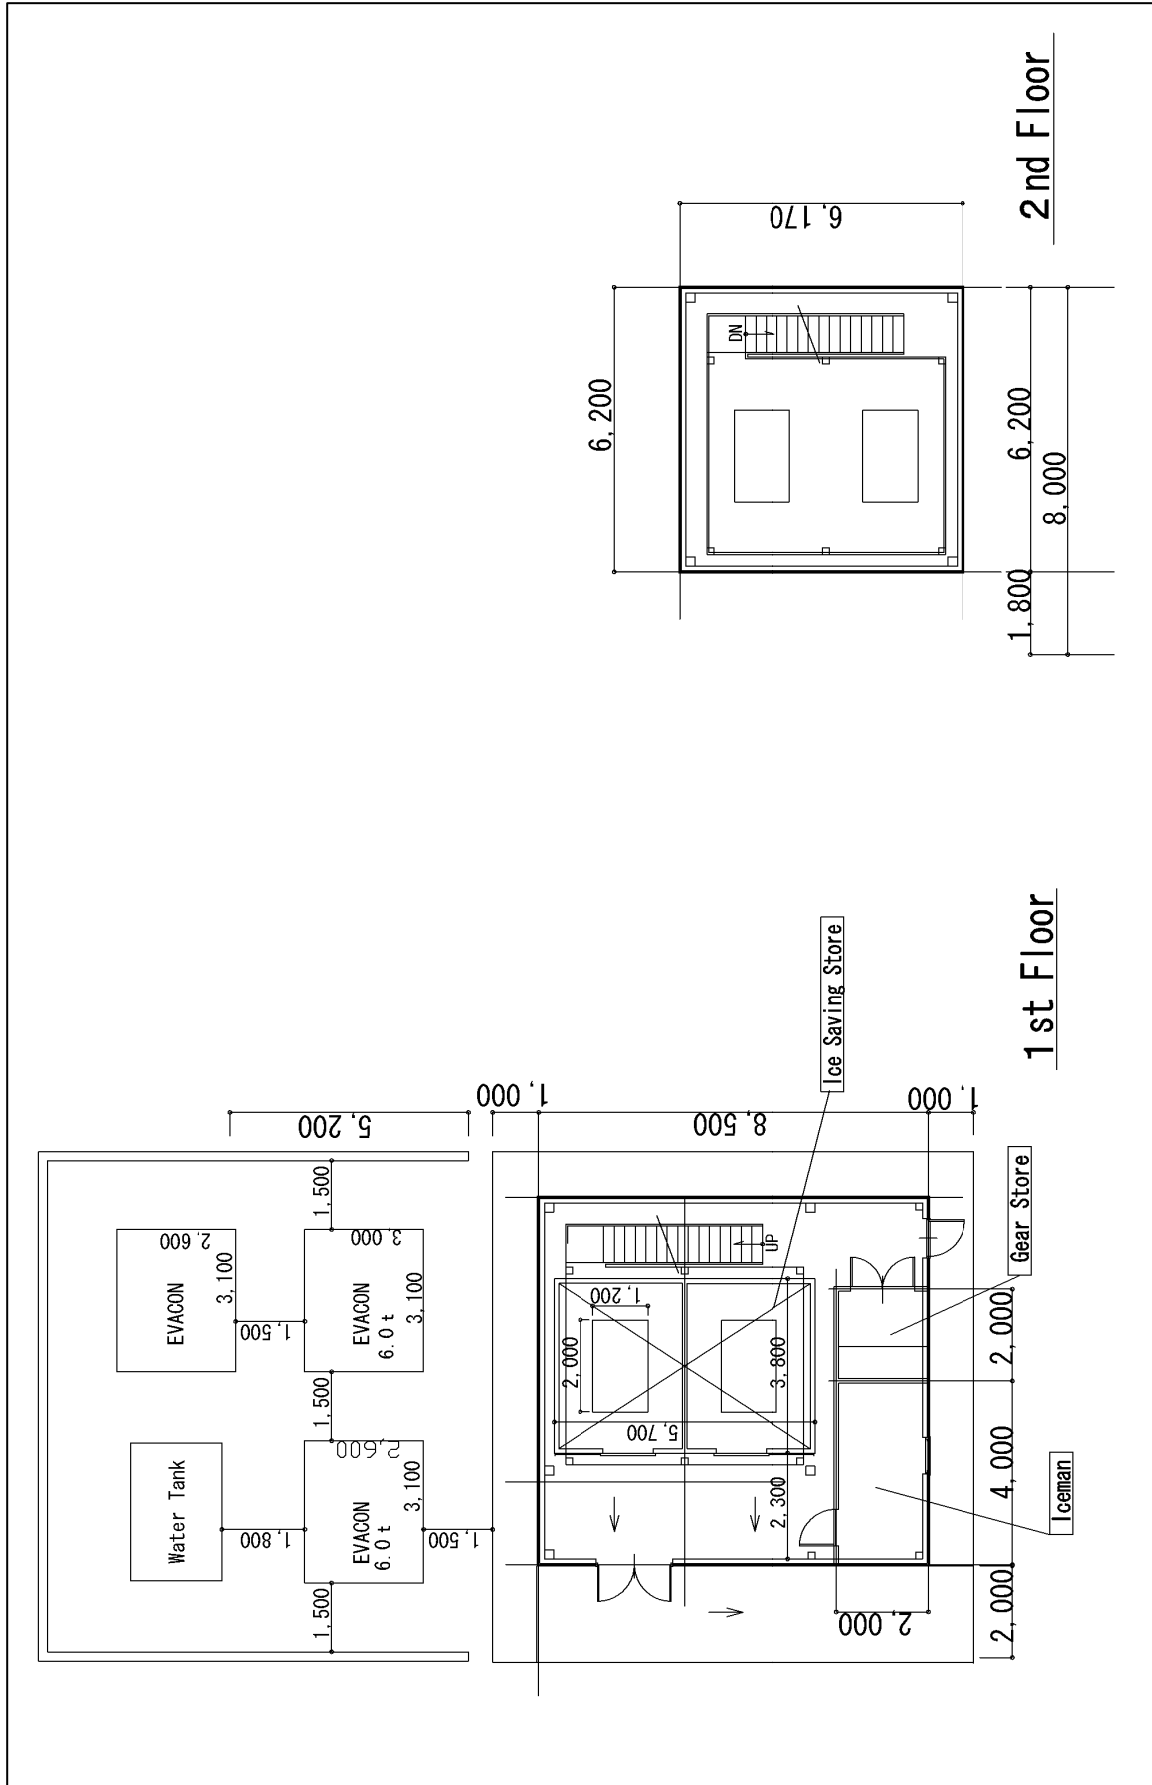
(7) 製氷機棟平面図 (ベル・オン泊レ漁港)
